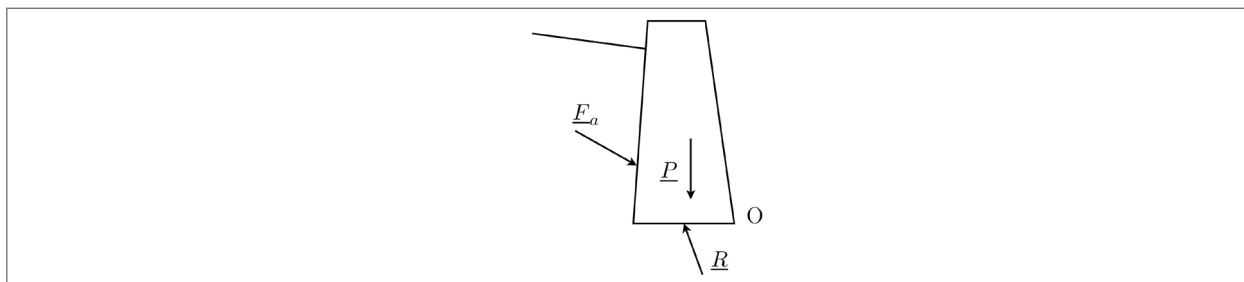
Équilibre des forces sur un mur-poids : poids propre du mur P, poussée du remblai F_a et réaction de la fondation R
